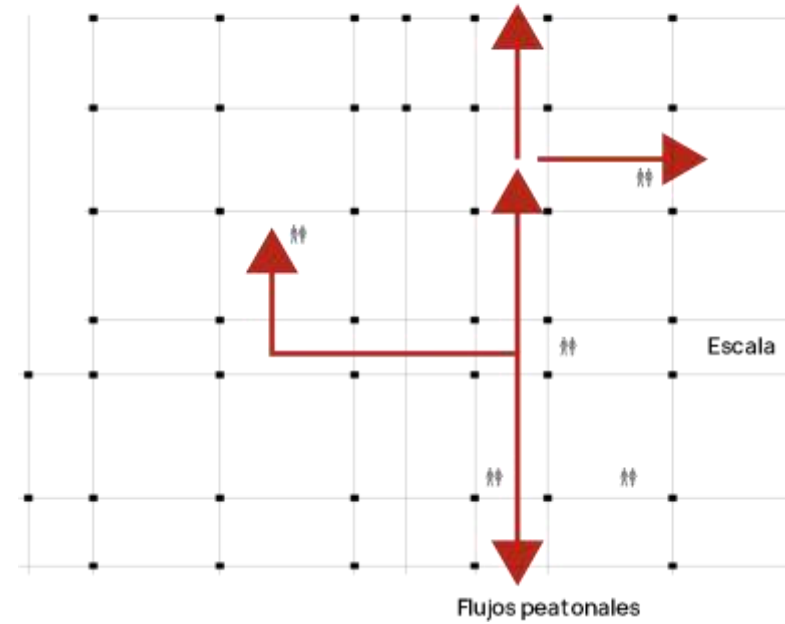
Modulación estructural Elaboración: Propia Fuente: Propia
